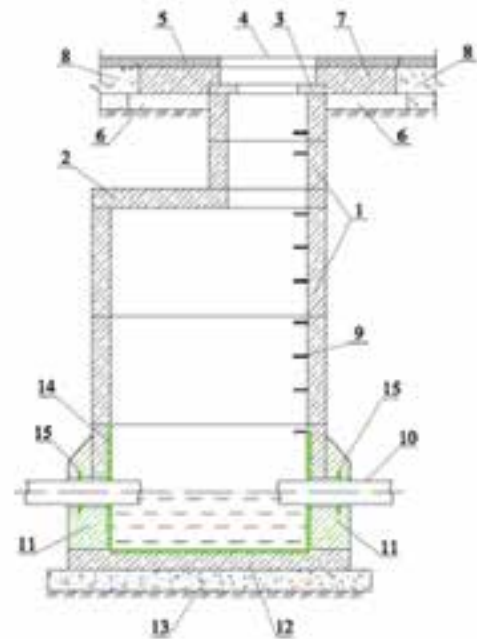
Конструкция круглого колодца: 1 — стеновые железобетонные кольца; 2 — плиты перекрытия; 3 — опорное кольцо; 4 — чугунный люк; 5 — асфальтобетон; 6 — песчаное основание; 7 — железобетонная плита с нишей для люка; 8 — щебеночное основание; 9 — ходовые скобы; 10 — трубы; 11 — монолитный бетон с добавкой MasterGlenium® для заделки отверстий в кольце; 12 — плита днища; 13 — подготовка под плиту днища; 14 — MasterSeal® M 336 или MasterSeal® M 338; 15 — набухающая паста MasterSeal® 912
